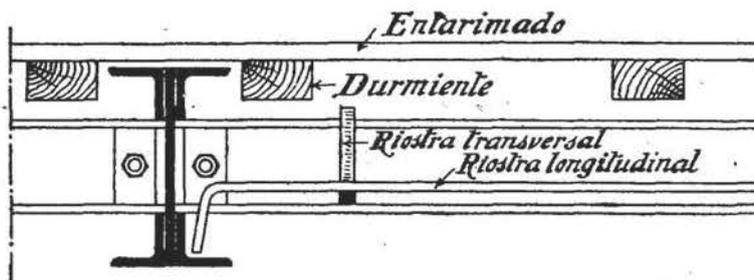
Ensambladura de las viguetas con la viga maestra: caso de un forjado de yesones con piso de entarimado.
